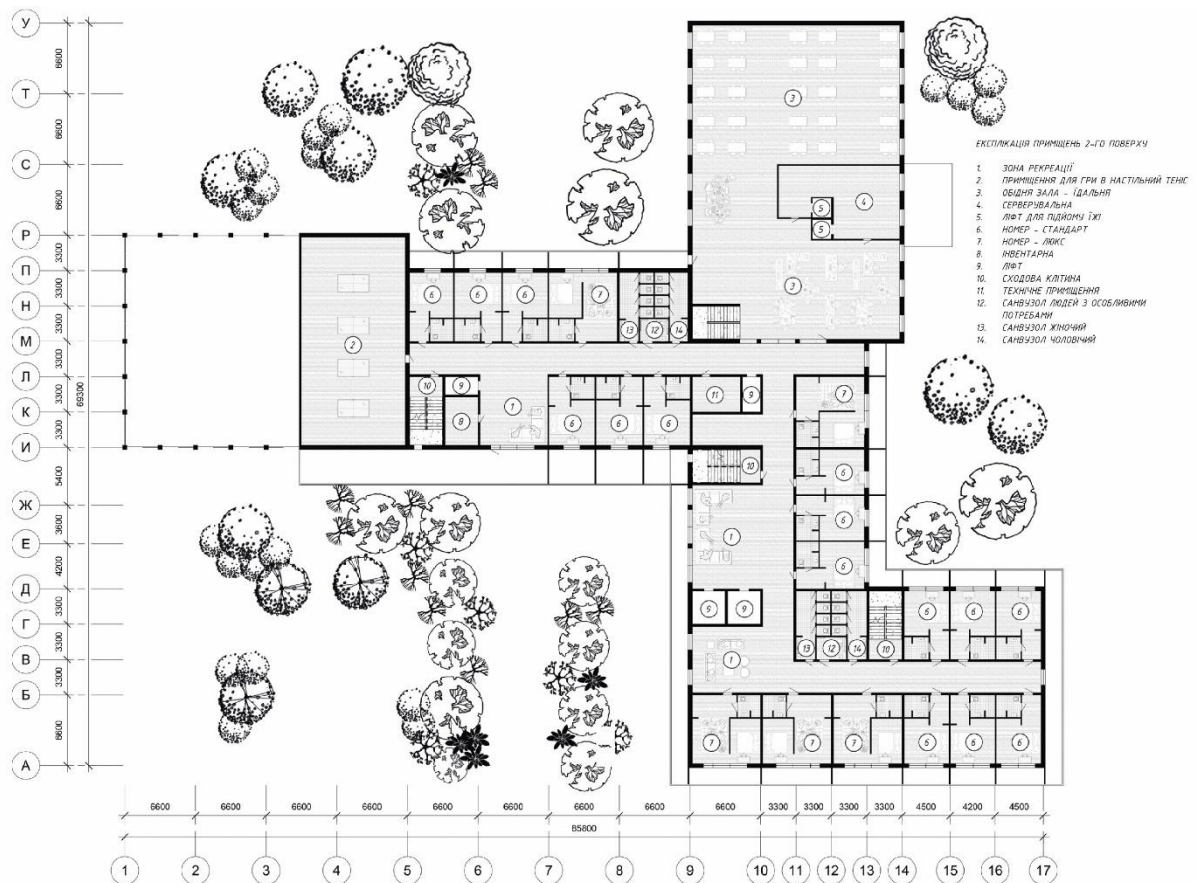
План 2-го поверху на відмітці 3.300 м
